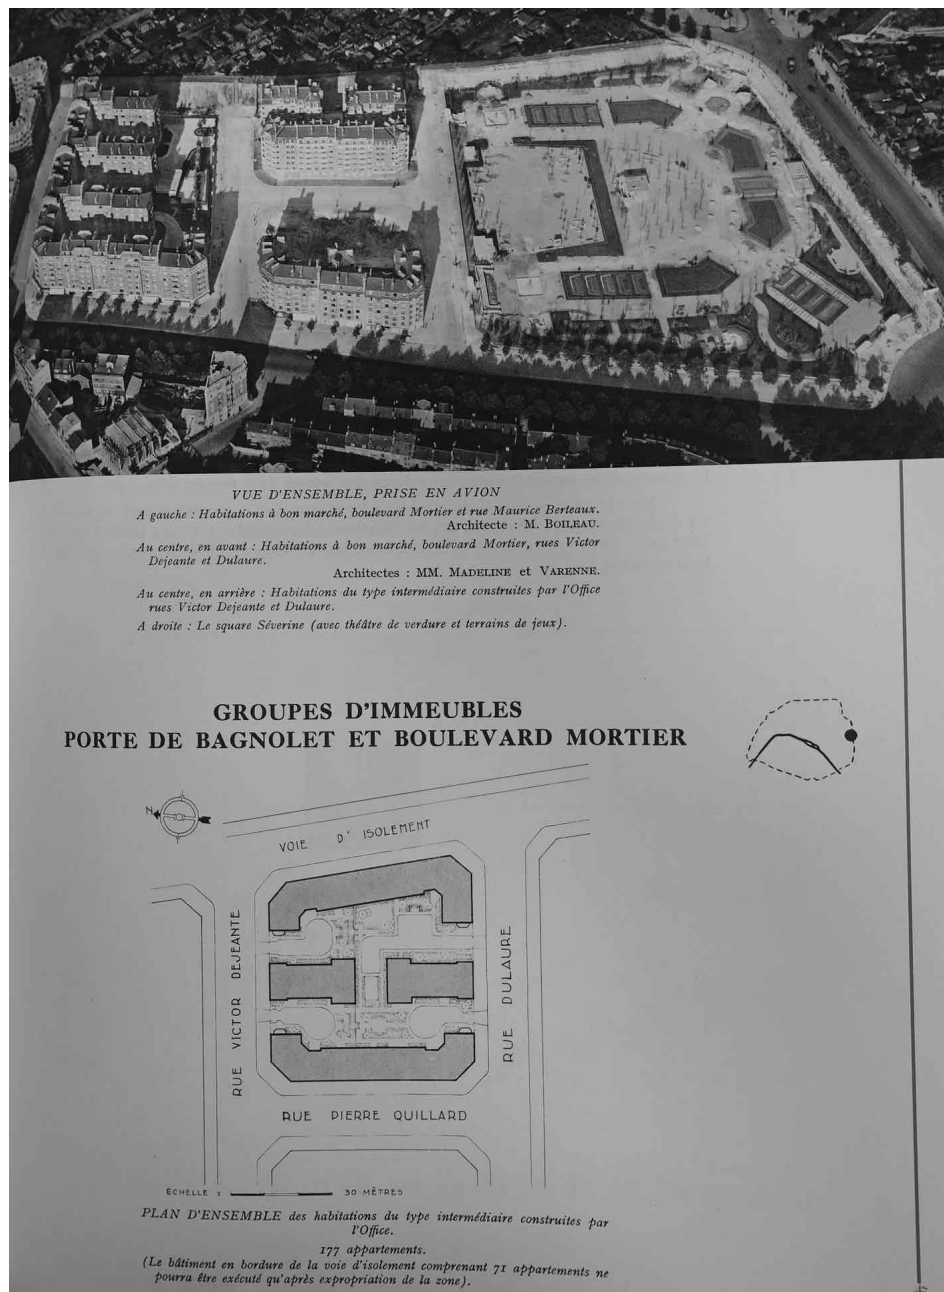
Agence de l'OPHBMVP, vue d'ensemble du groupe d'immeubles porte de Bagnolet et Boulevard Mortier et plan du 3<sup>ème</sup> lot de bâtiments construits sur l'emplacement du bastion 15, OPHBMVP, *Réalisations*, *op.cit.* pl. 171.
